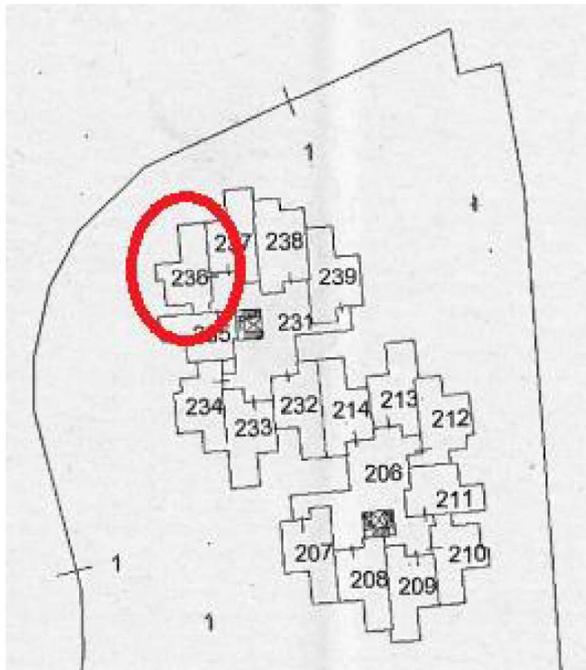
Elaborato planimetrico con indicazione del sub 236.
